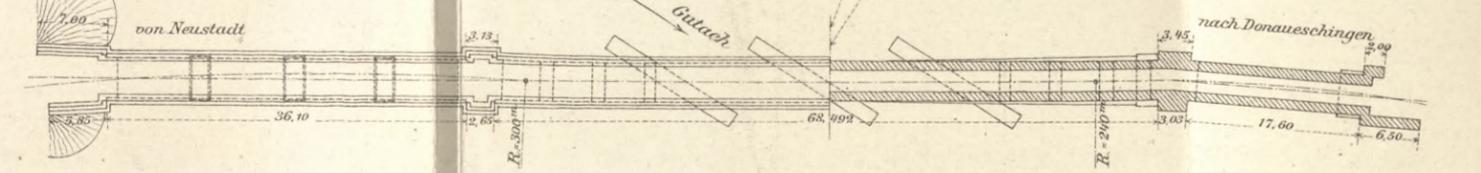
Schwändeholzobelbrücke in der Bahn: Neustadt-Donaueschingen. M. 1: 750.
